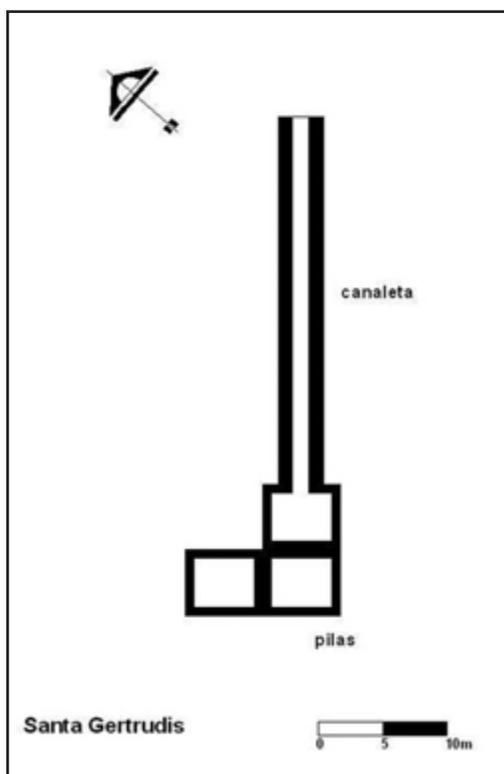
Vista de planta de los restos del Ingenio Santa Gertrudis, Metapán, Santa Ana.
